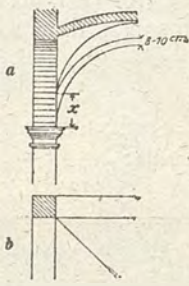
Volta a crociera su archi di testa senza spalle, ossia su pilastrini senza alette.
